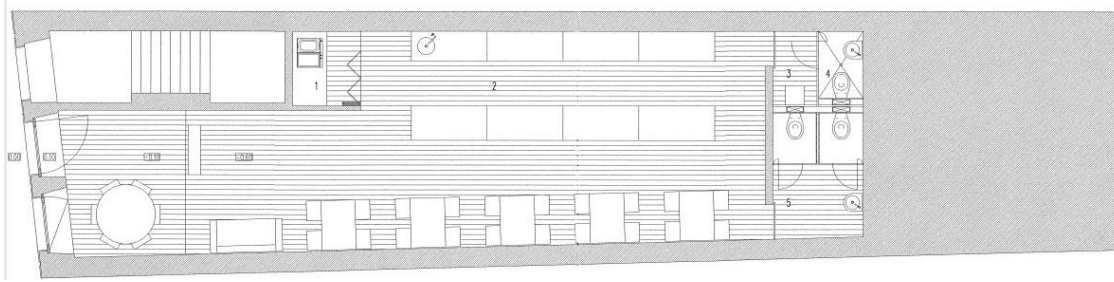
Planta da proposta - Esc. 1/200 – Autor do projeto
